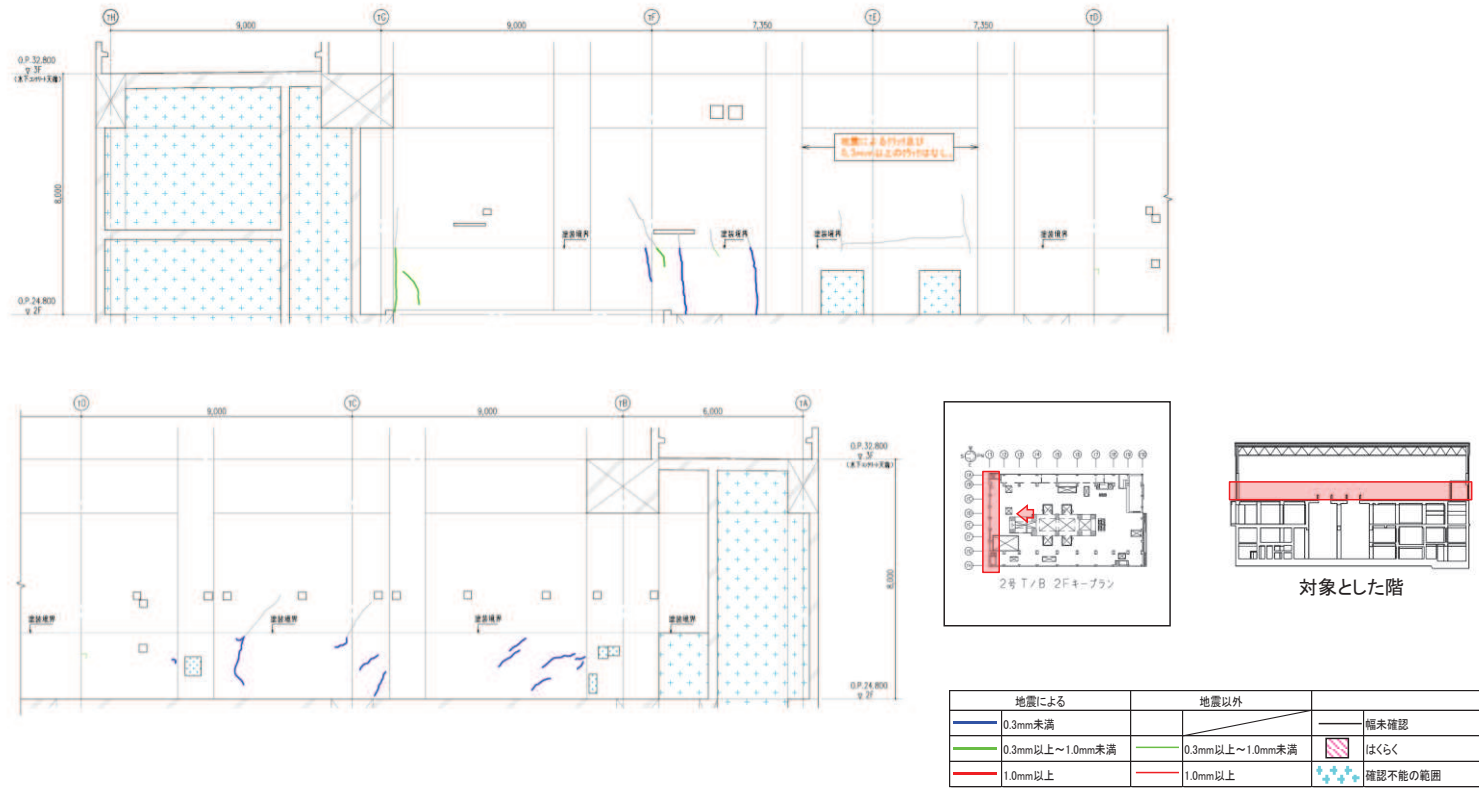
タービン建屋のひび割れ分布 耐震壁 (49) 2階 T1 通り
